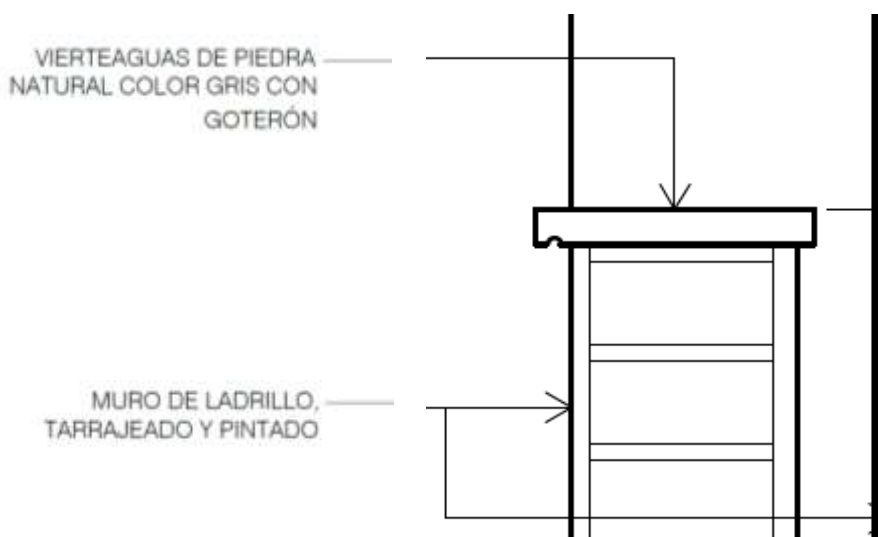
Detalle referencial del vierteaguas de piedra.
